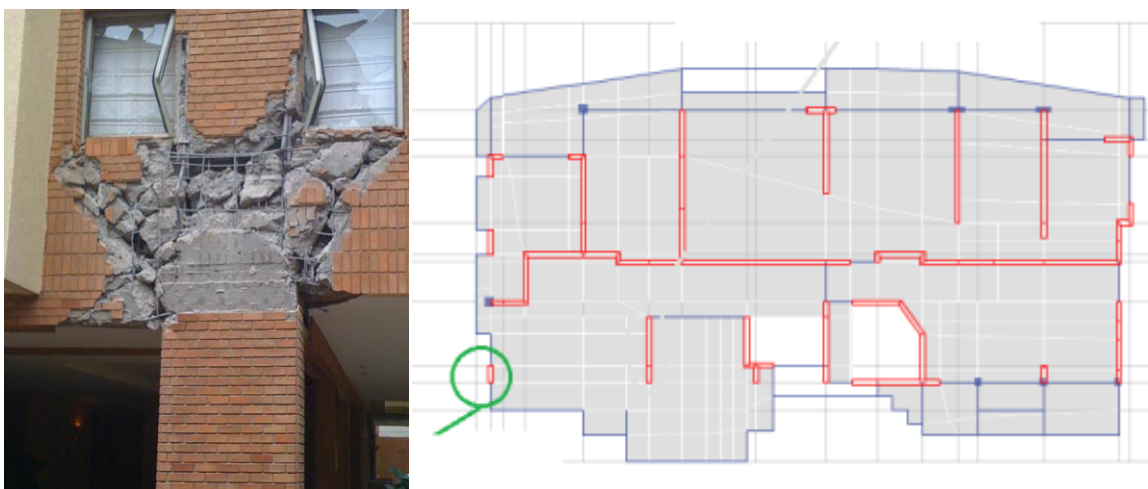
Imagen del daño y ubicación en planta del elemento T15-1
